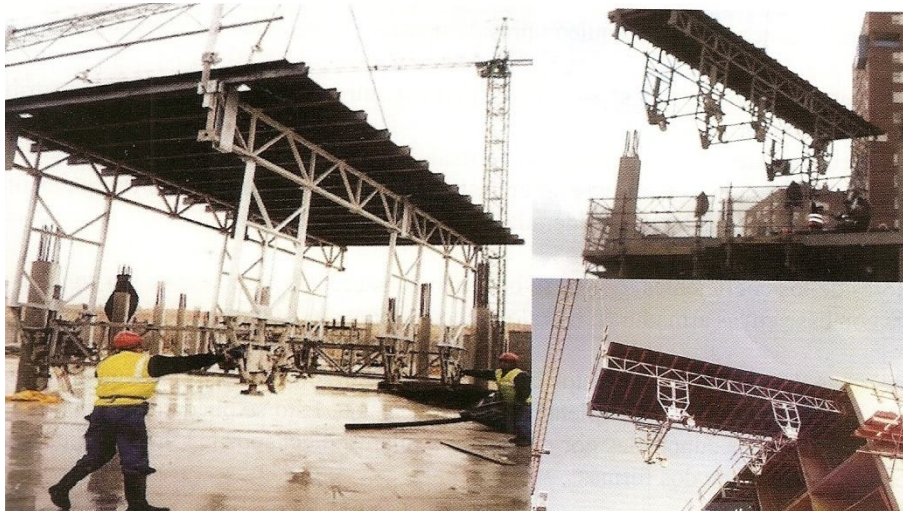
Elevação de mesas auto-móveis (Peri, 2008)
